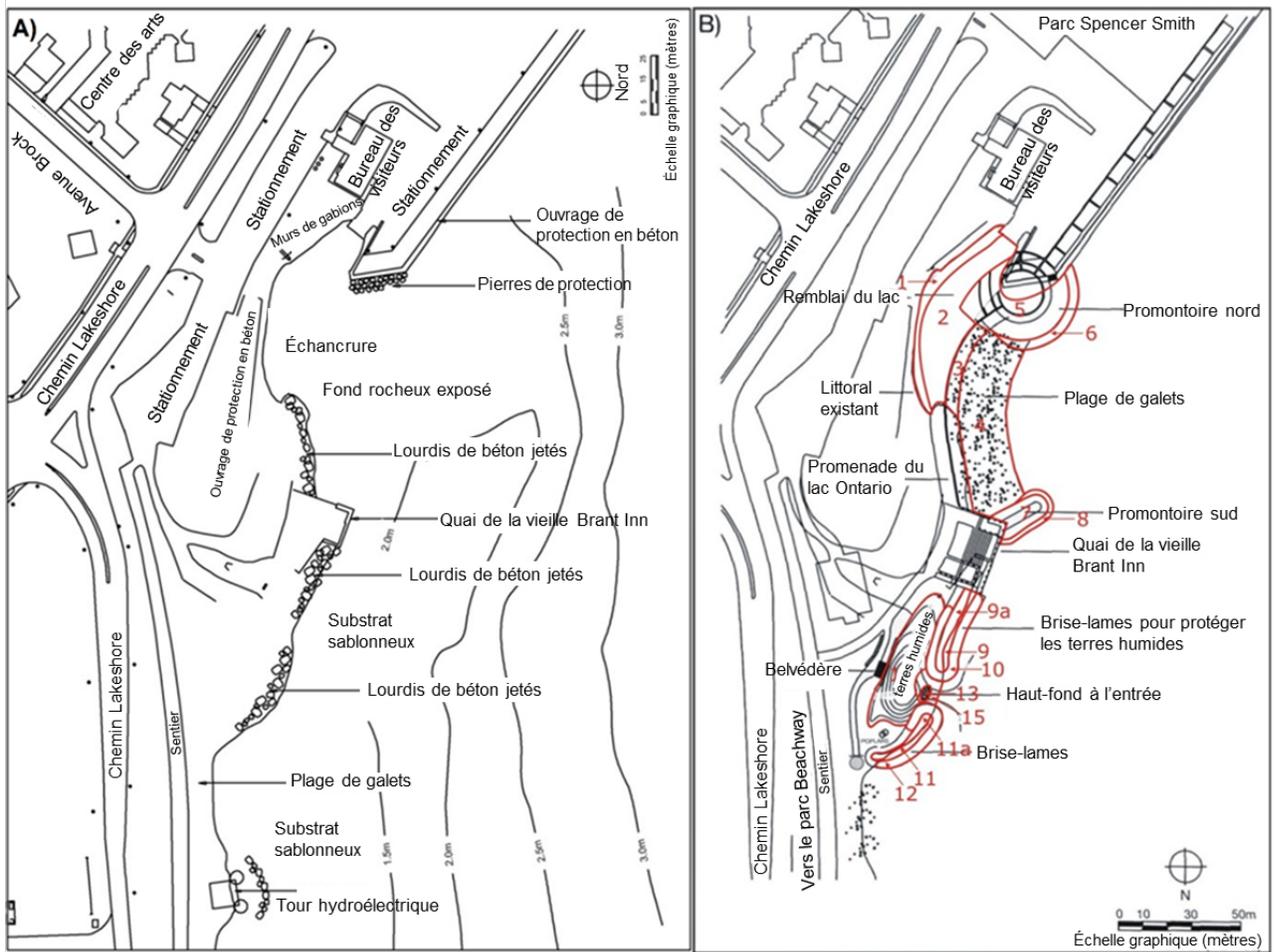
Nœud de Brant Inn, Burlington (Ontario), plans du site avant et après la construction. Le dessin de gauche (A) montre l'état avant la construction (voir les photographies du site avant la construction sur la Figure 6) et le dessin de droite (B) représente les modifications prévues par le projet (voir les photographies du site après la construction sur la Figure 7).
